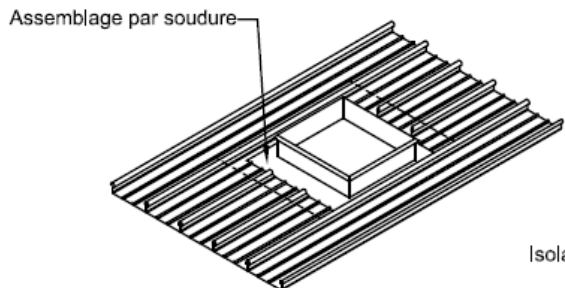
Pénétration raccordée au Kalzip® par soudure
